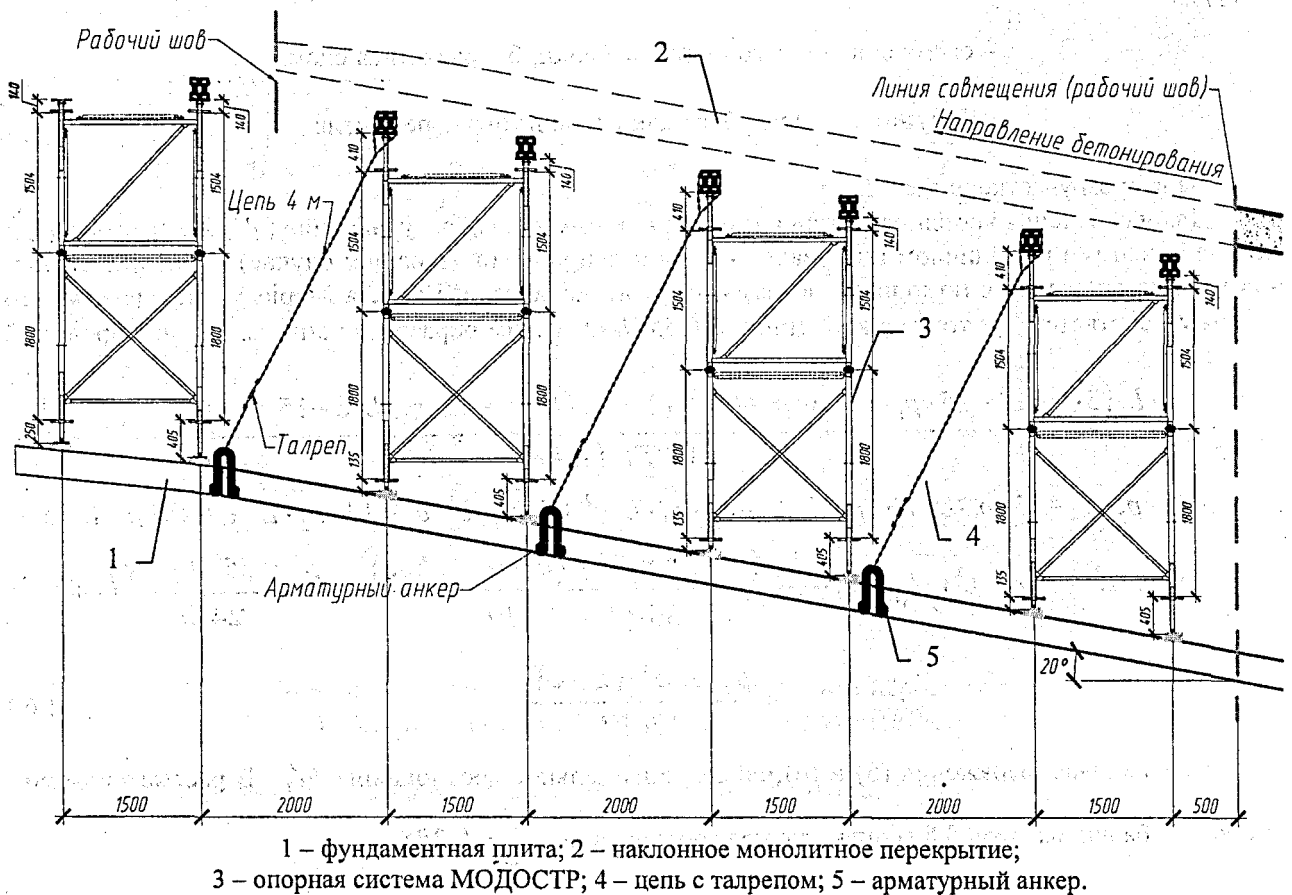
Схема опалубки наклонного перекрытия на последующих захватках.
